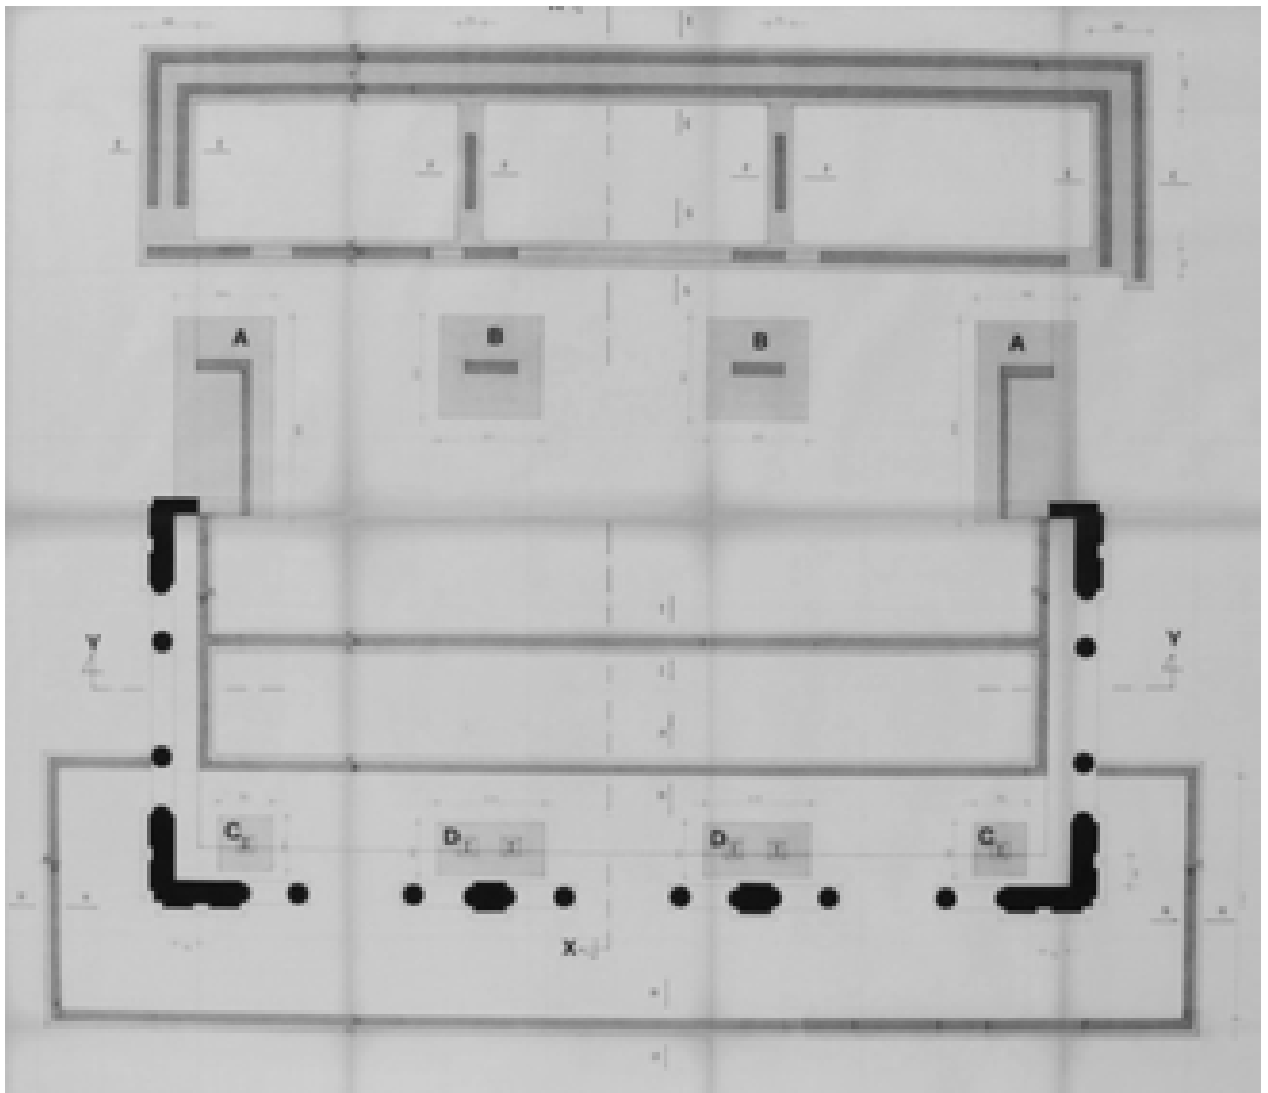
Progetto esecutivo delle fondazioni, planimetria, gennaio 1987 (AABS-175)
